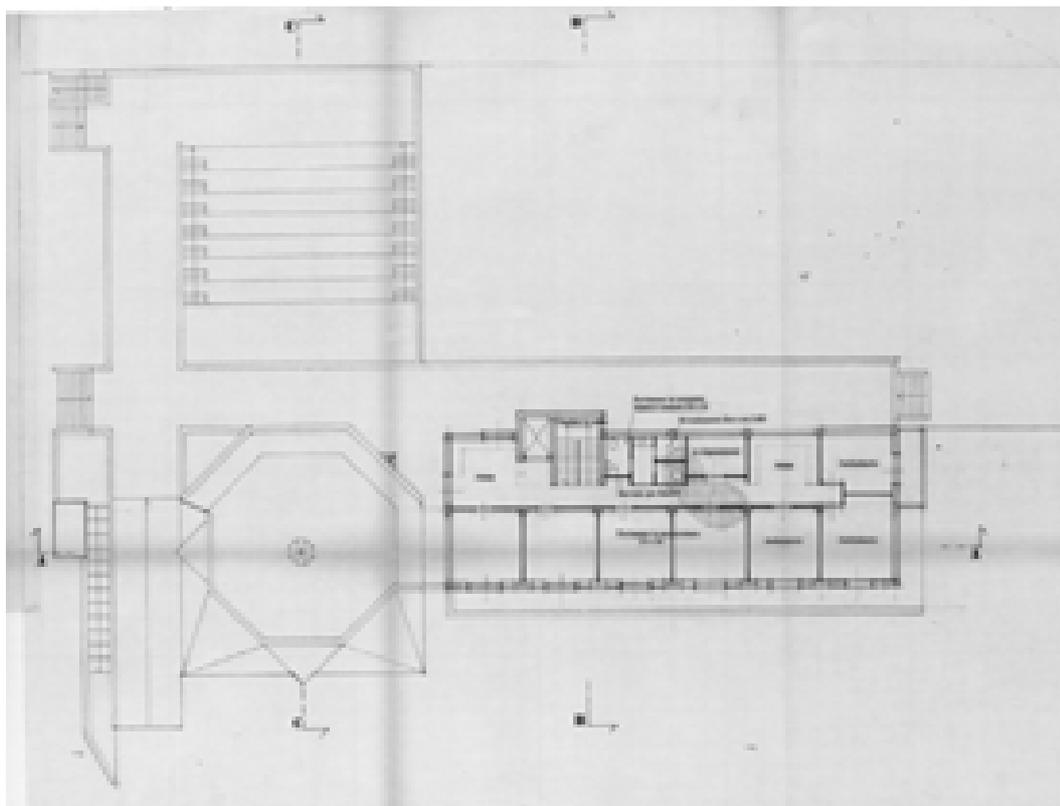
Pianta +4,00 – 02/08/1994 (AABS-64_651)
